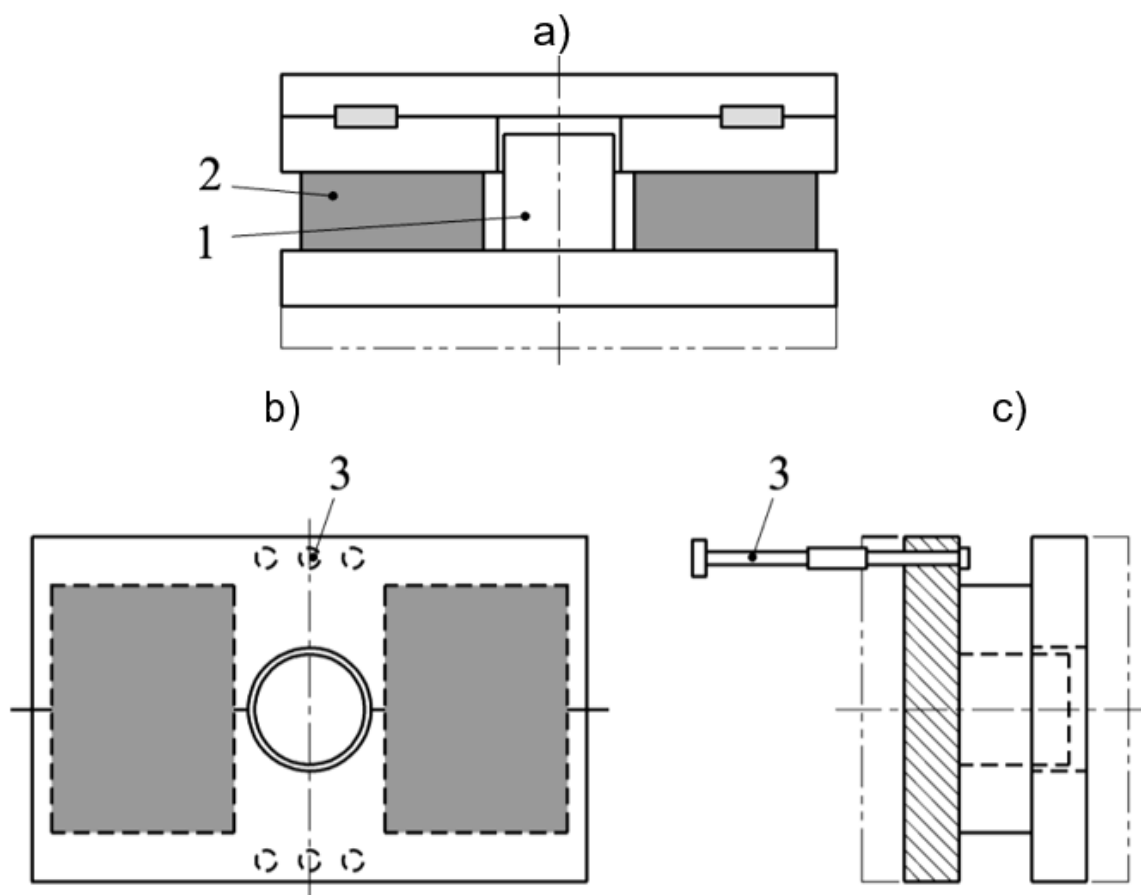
Przykłady łożysk stalowych prowadzących: a- widok z boku, b- przekrój poprzeczny, c- widok aksonometryczny; 1- elementy ślizgowe, 2- elementy przegubowe
